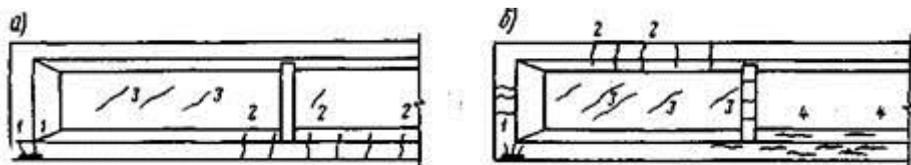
Характерные силовые трещины в железобетонных пролетных строениях
